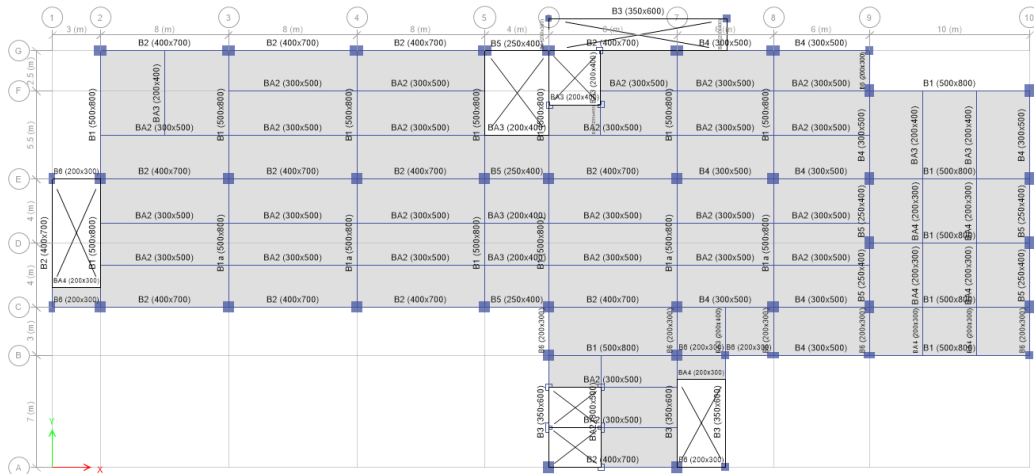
Denah Lantai 1 (EL. +0.00)
